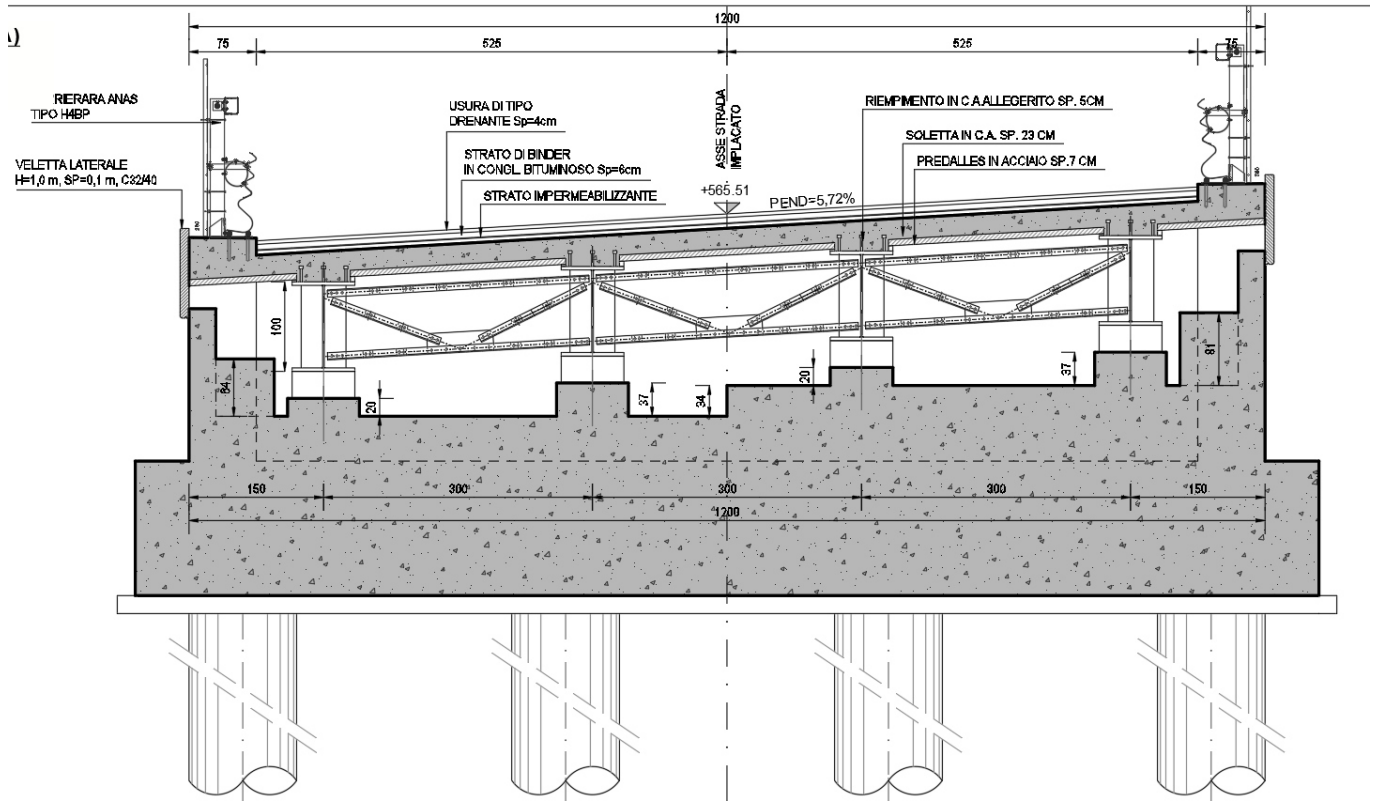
SEZIONE TRASVERSALE DELL'IMPALCATO IN SPALLA
